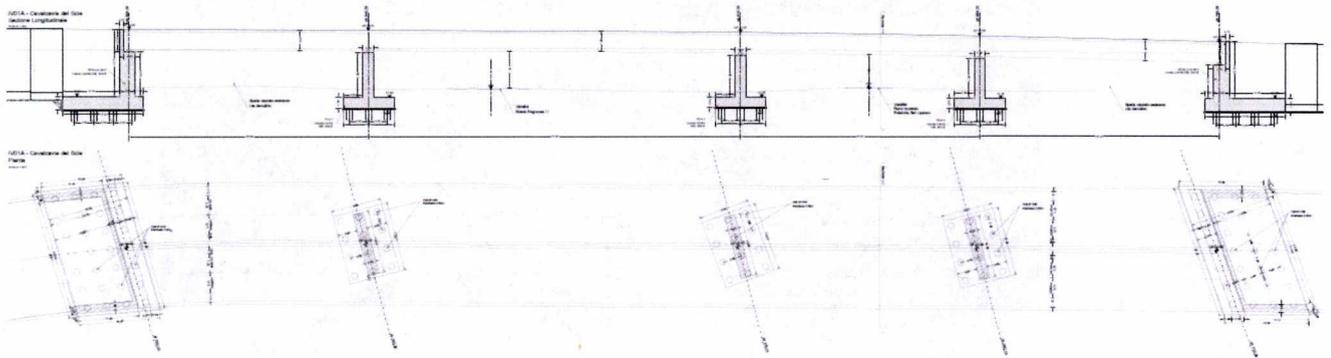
Planimetria e Profilo del Cavalcavia del Sole
